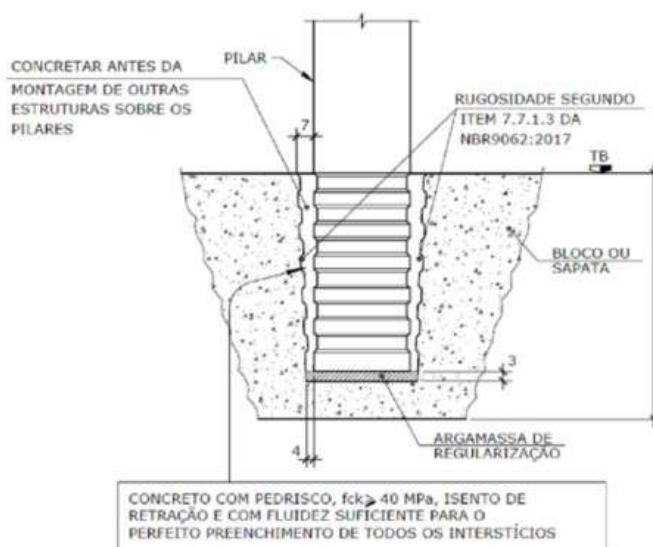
Detalhe do embutimento de pilar pré-fabricado em elemento de fundação
